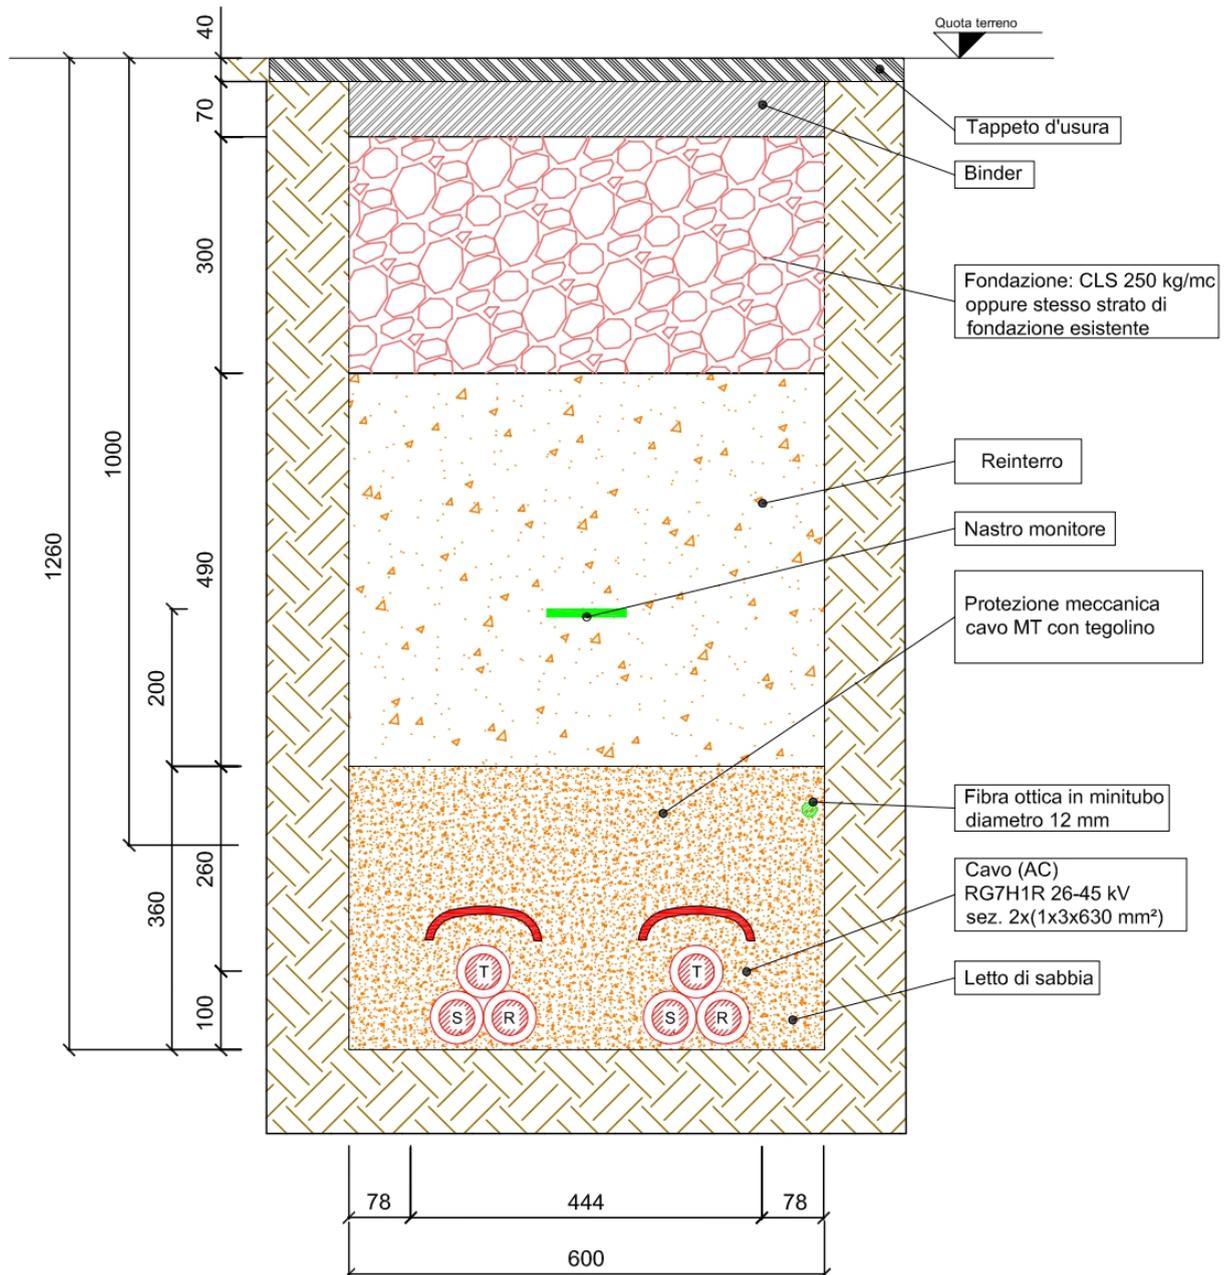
Tipico sezione di posa con due cavidotti esterni da 3x630 mm²
